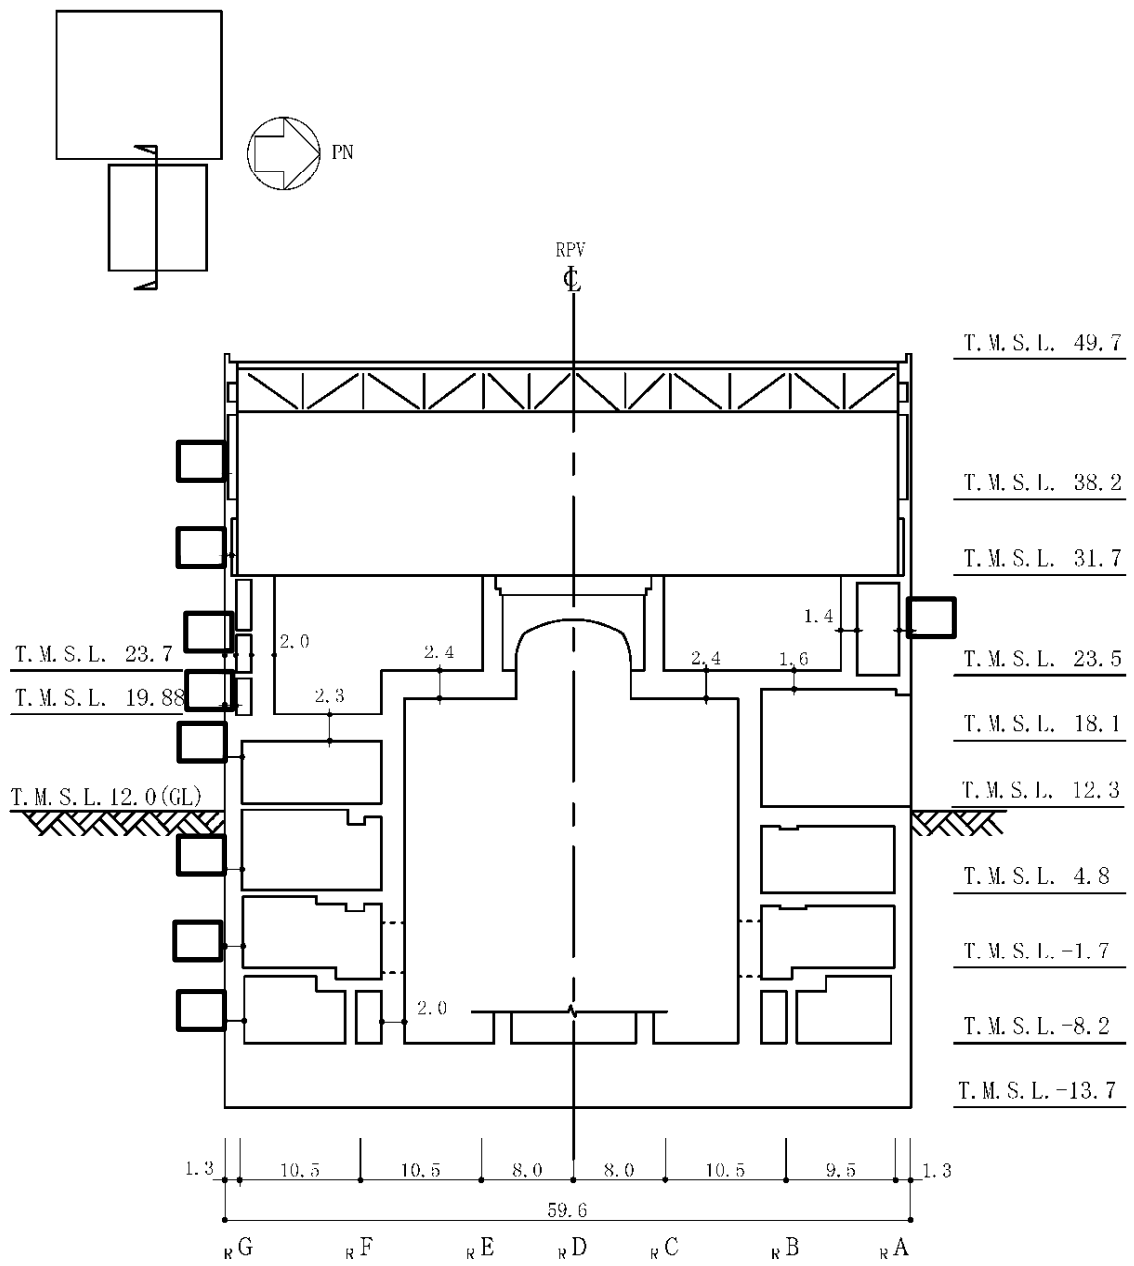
原子炉建屋の概略断面図 (EW方向) (2/2) (単位 : m)
